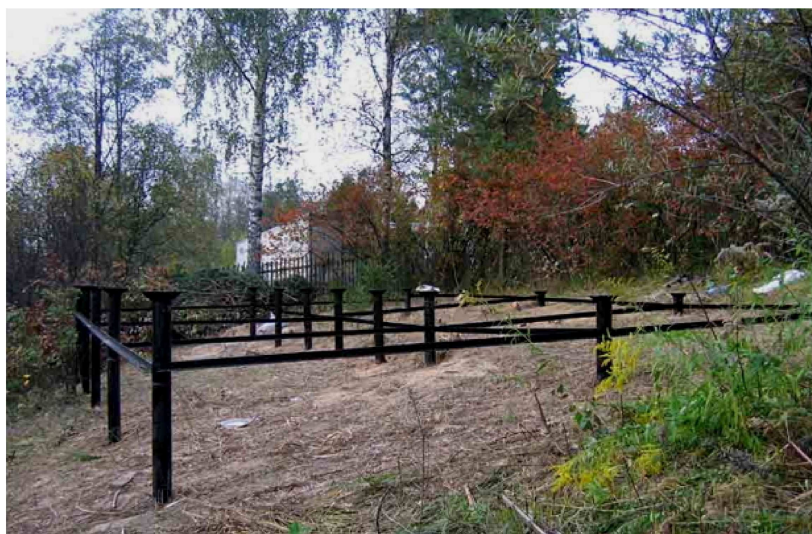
Приварка перевязки свайного фундамента на откосе
